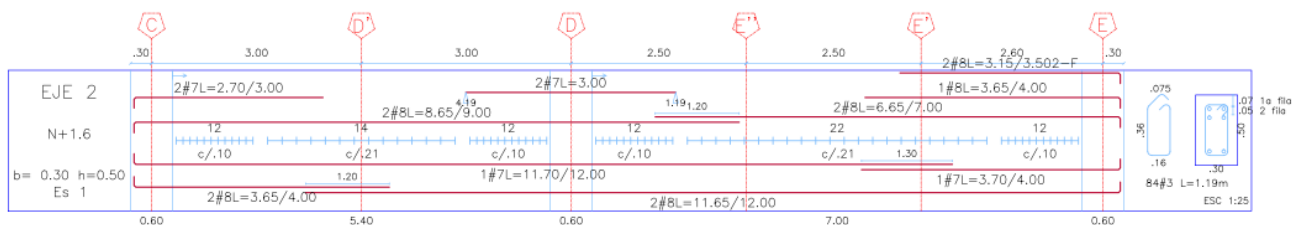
Detalle despiece viga de cimentación Eje 2. Fuente: Planos del proyecto
